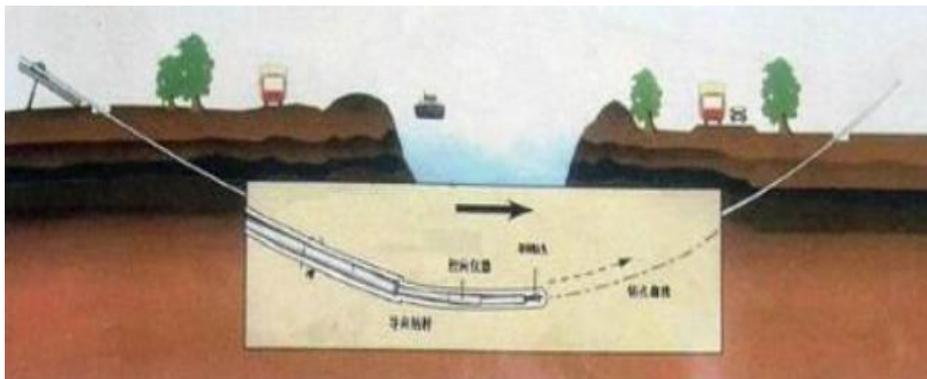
定向钻穿越施工钻导向孔过程断面示意图
